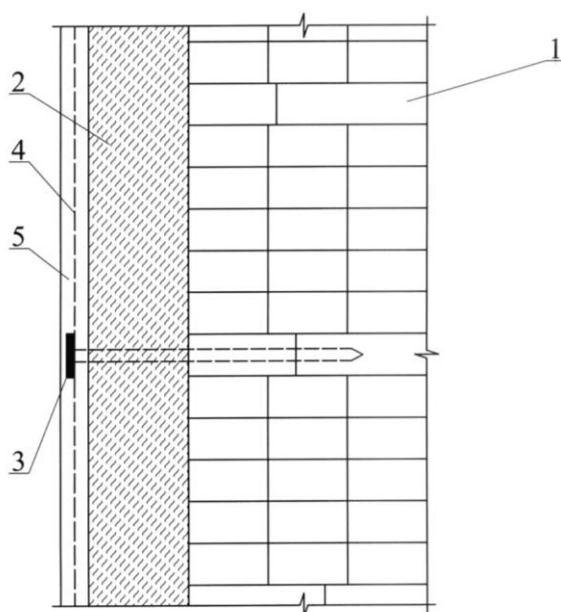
Вариант отделки фасада мокрой штукатуркой по пластмассовой сетке при утеплении стены снаружи:
